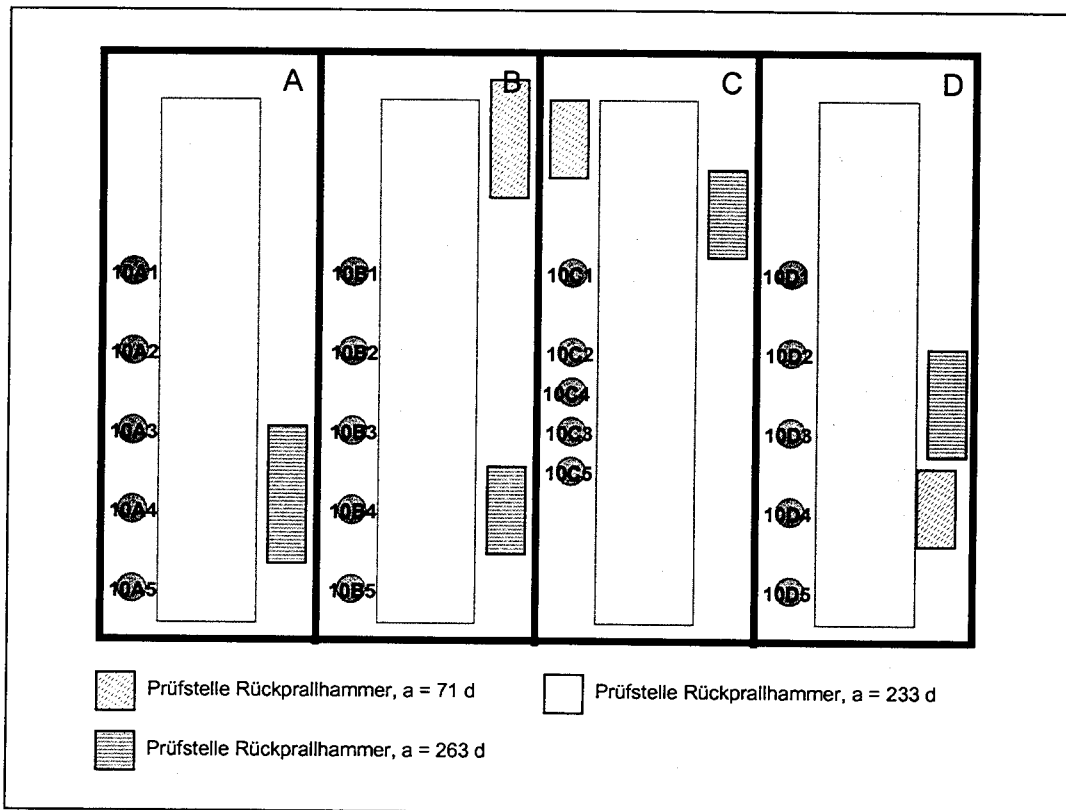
Lage der Prüfflächen am Betonkörper 7
